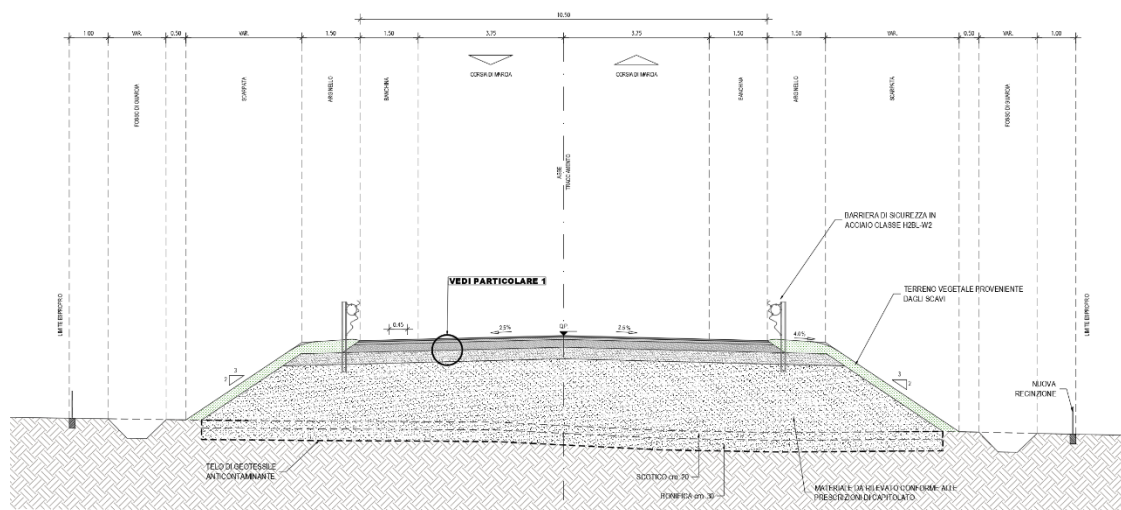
Sezione tipologica dell'asse principale in rilevato (rettifilo)
